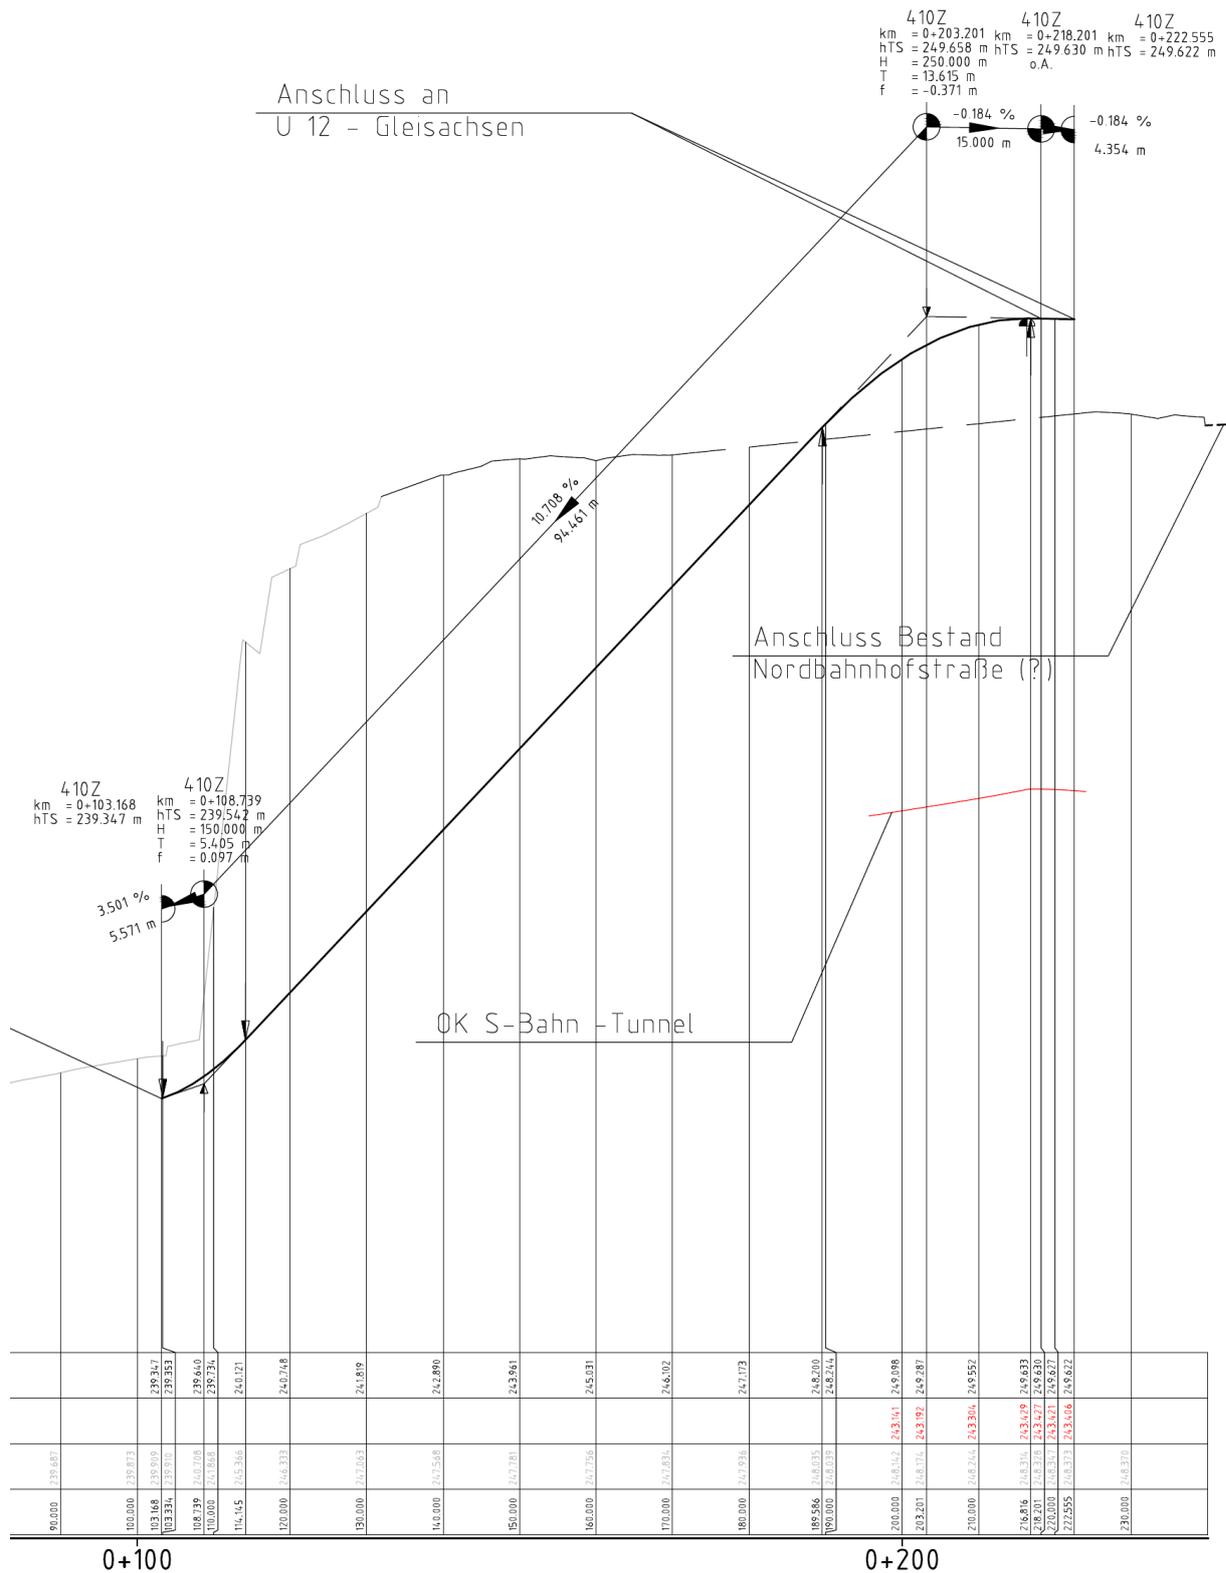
Ausschnitt Höhenplan Rampe „Nord“ der planfestgestellten Lösung
